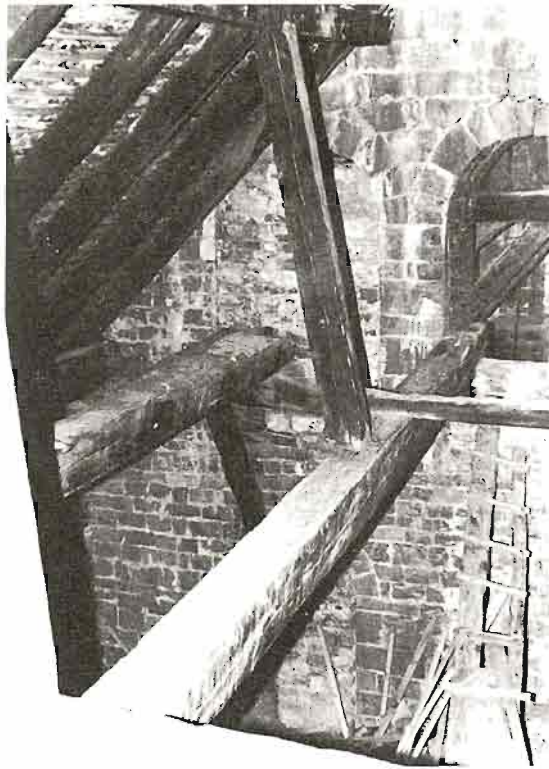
Tejado vertiente oeste. Al fondo, muro de la torre con antigua puerta de acceso a las bóvedas y huecos de las campanas (iglesia anterior). Estado anterior a la restauración.
